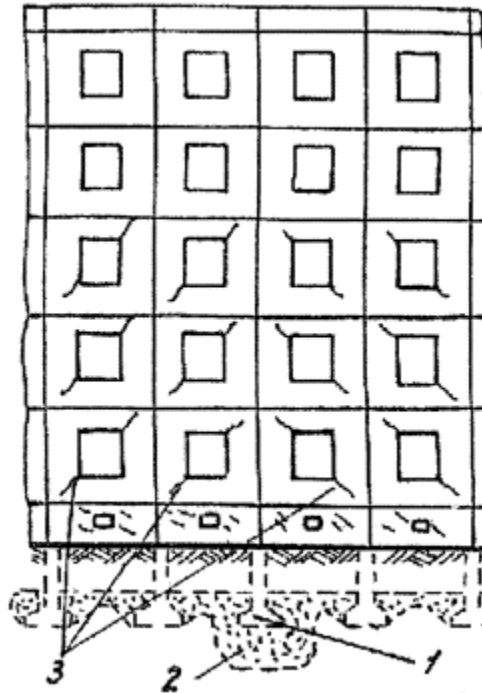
Схема трещин в стене крупнопанельного здания от неравномерной осадки фундаментов:
